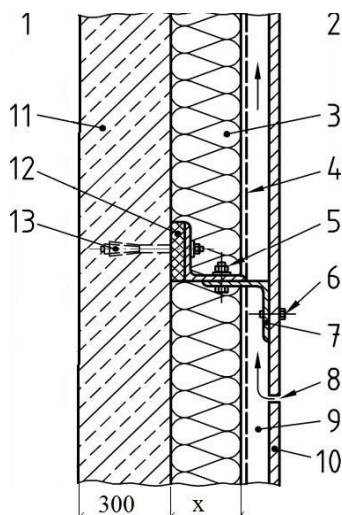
Конструктивное решение ограждающей конструкции здания: 1 – внутри; 2 – снаружи; 3 – утеплитель; 4 – паропроницаемый барьер; 5,6 – крепежные элементы; 7 – подконструкция; 8 – зазор; 9 – вентиляционная полость (зазор); 10 – наружная облицовка; 11 – панель из поризованного керамзитобетона $\delta = 300 \text{ мм}$; 12 – терморазрыв; 13 – распорный анкер
